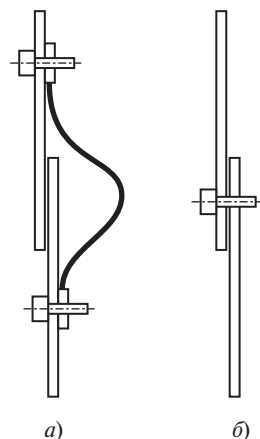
Соединение металлических частей фасада здания гибким проводом (а) или болтом (б)
